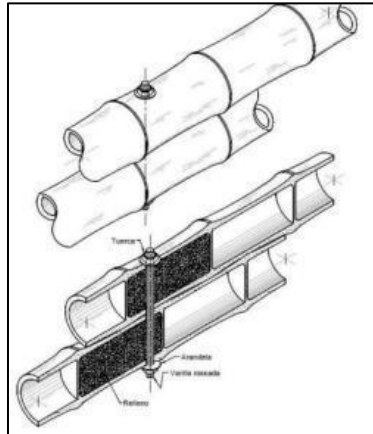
Detalle de conectores secciones compuestas Fuente: (NEC-SE-GUADUA, 2016)
